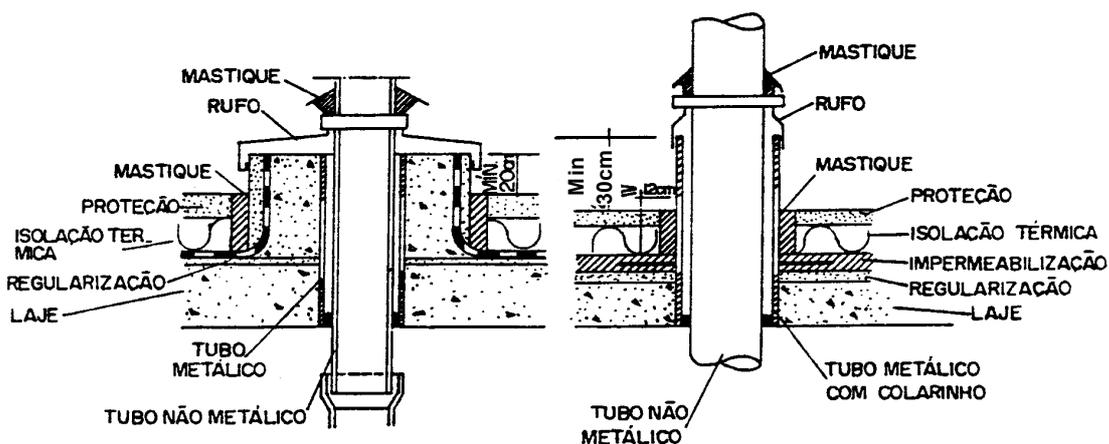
Peças que atravessam a impermeabilização – tubo não metálico
